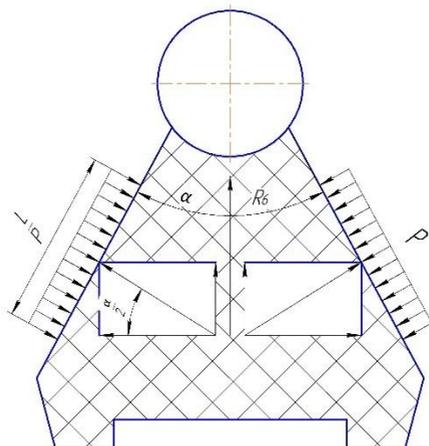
Расчетная схема нагрузки, действующей на трубопровод в процессе уплотнения грунта под ним
